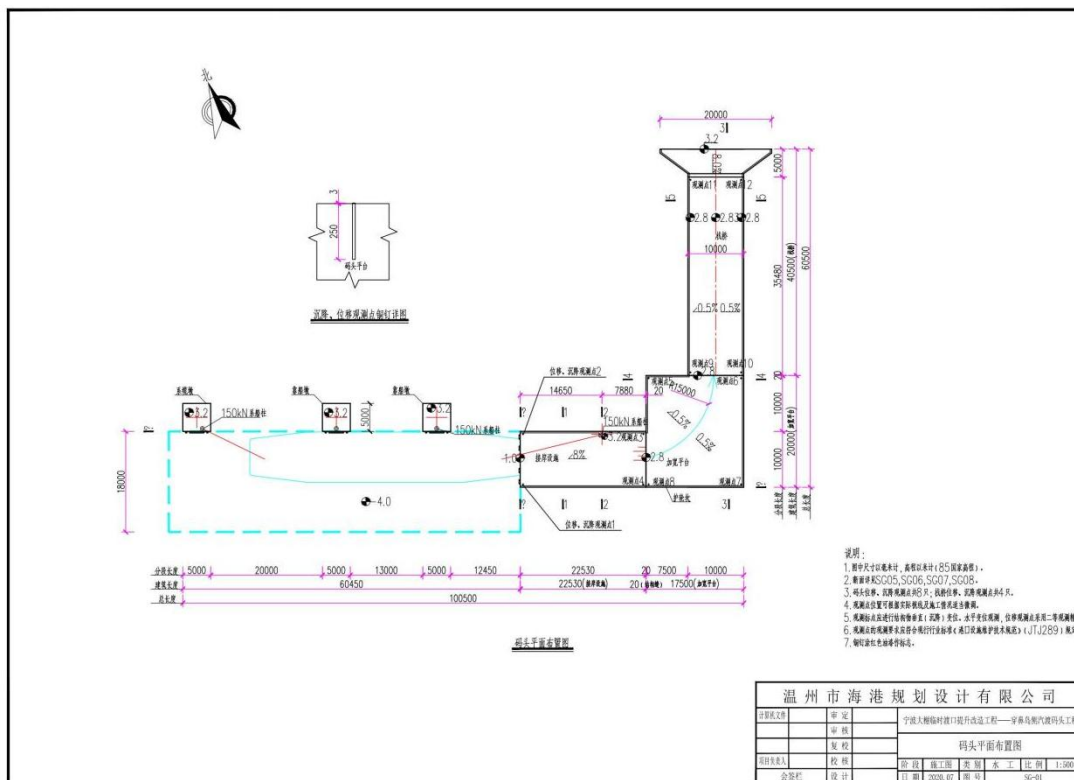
穿鼻岛侧汽渡码头平面布置图
